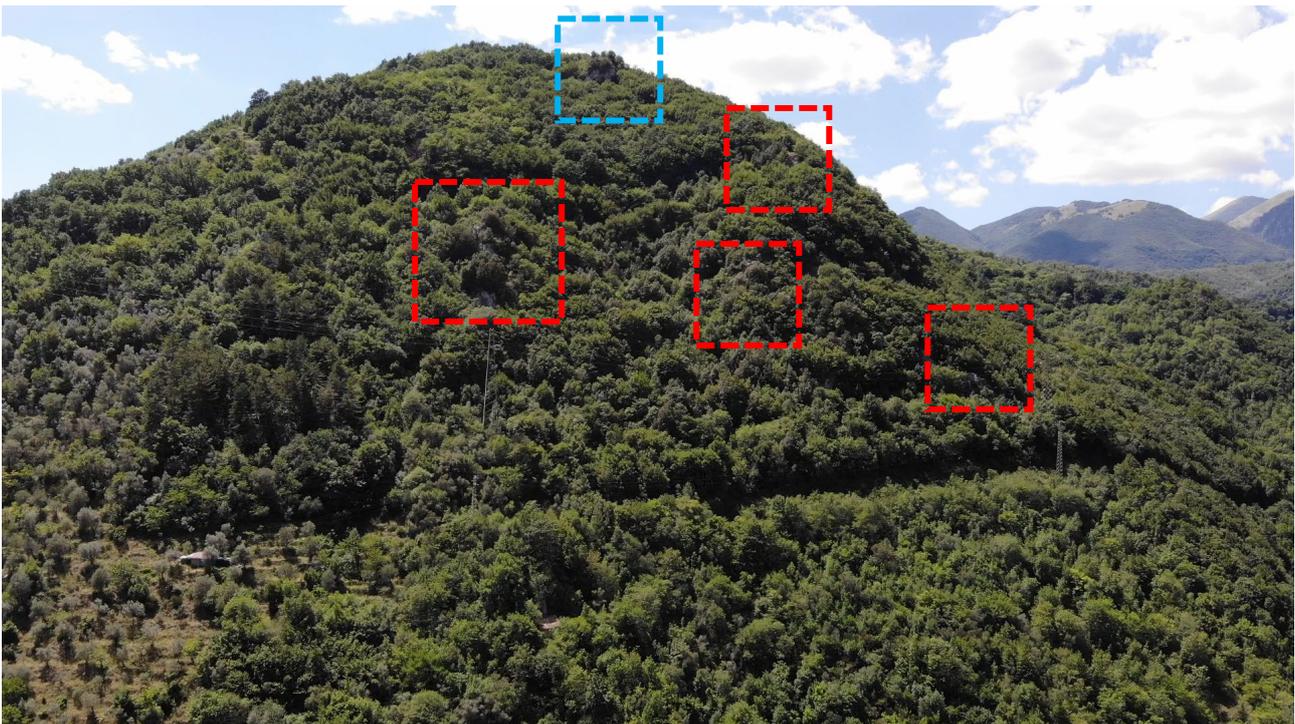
Vista dell'affioramento oggetto di intervento e delle
